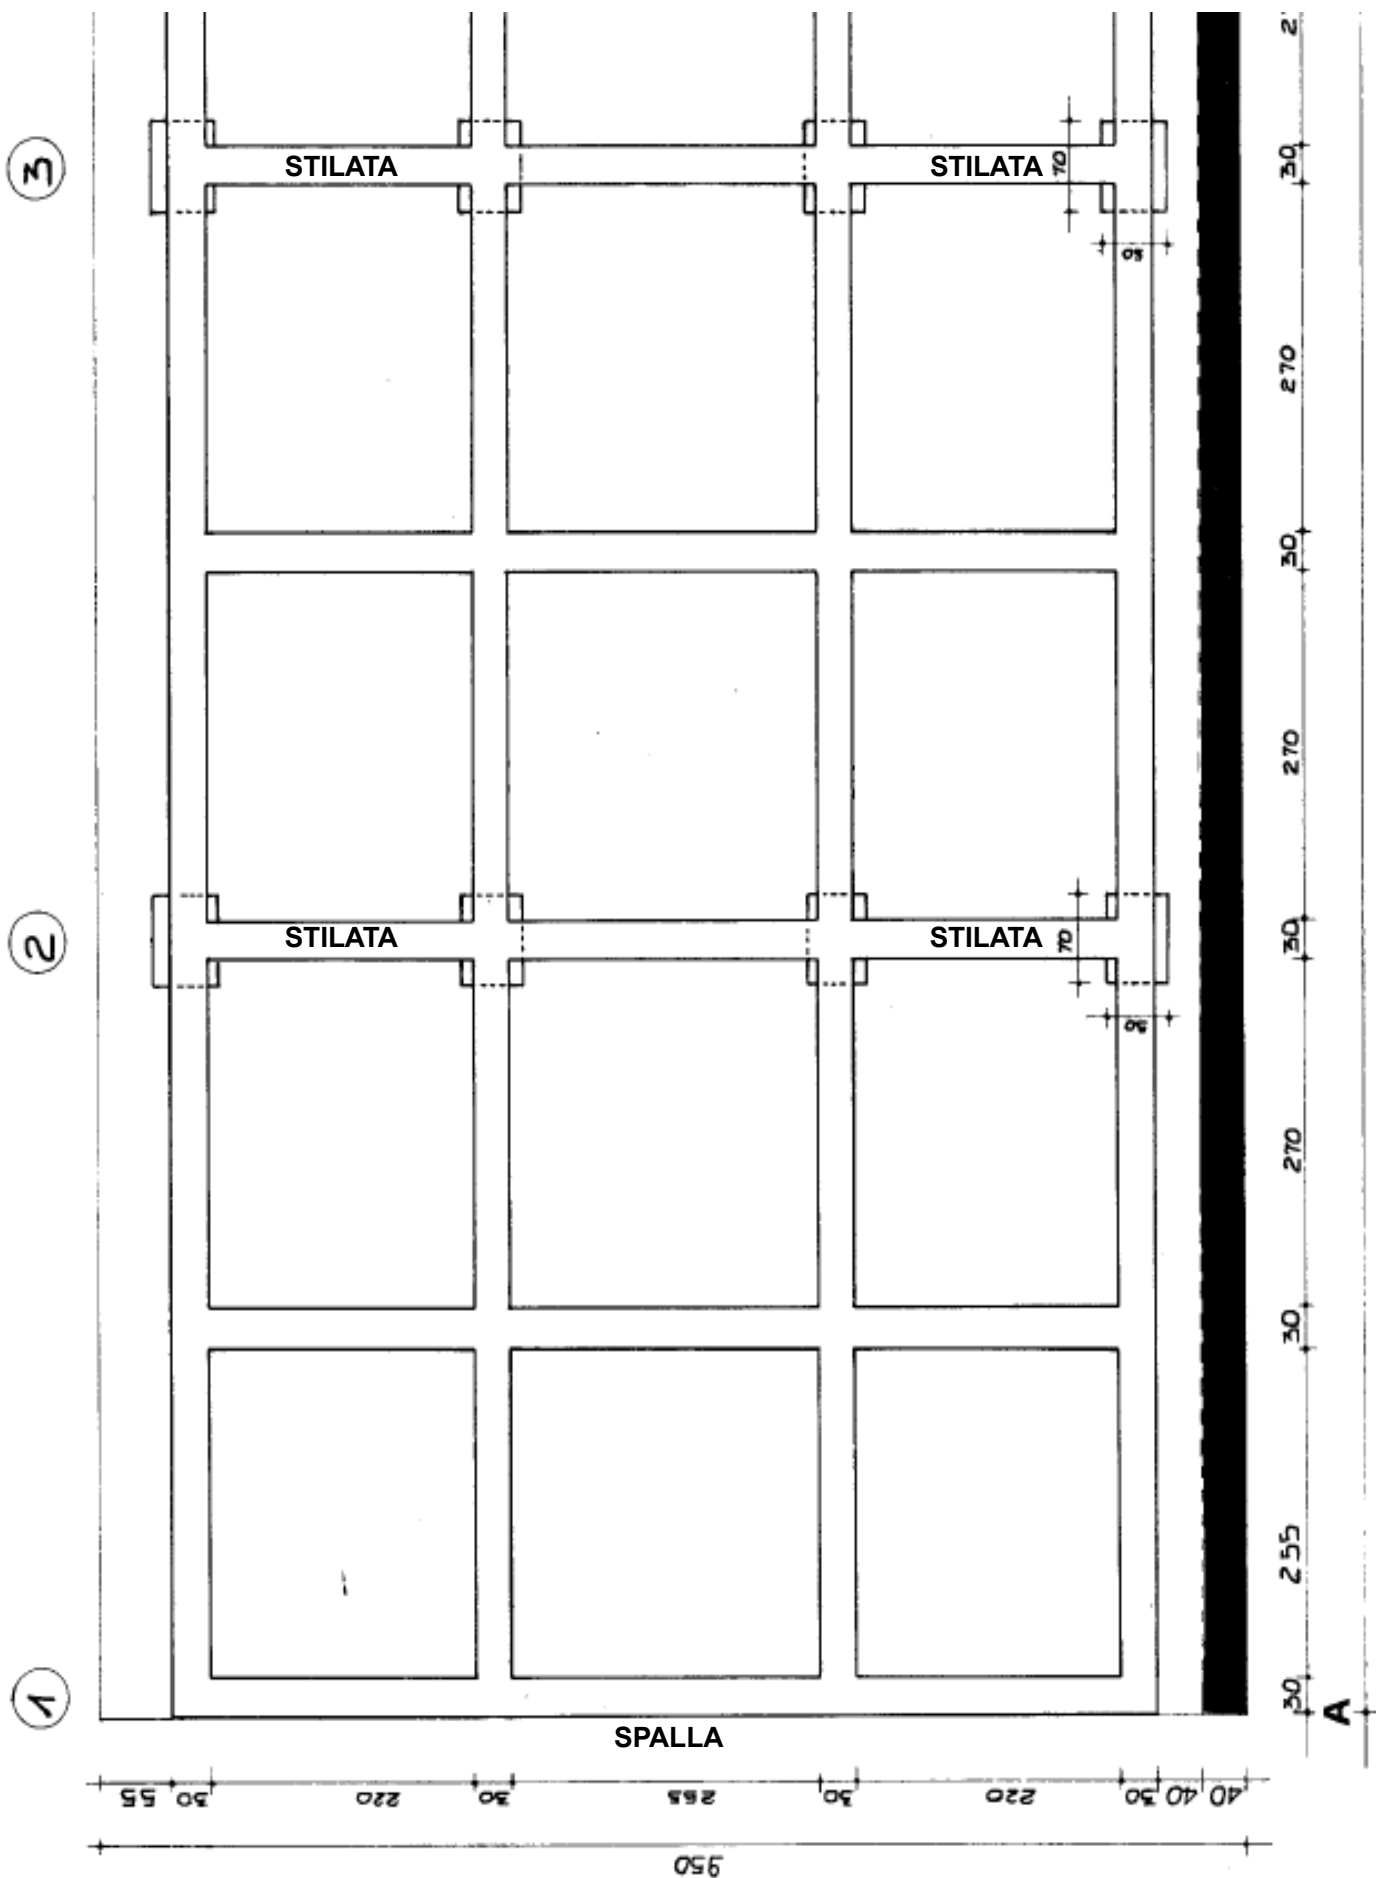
Dettaglio dello stato di fatto della pianta con orditura travi – struttura “a cassettoni” (e traccia pile) del ponte TENZA [n16.B], prime 2 campate dalla spalla.
